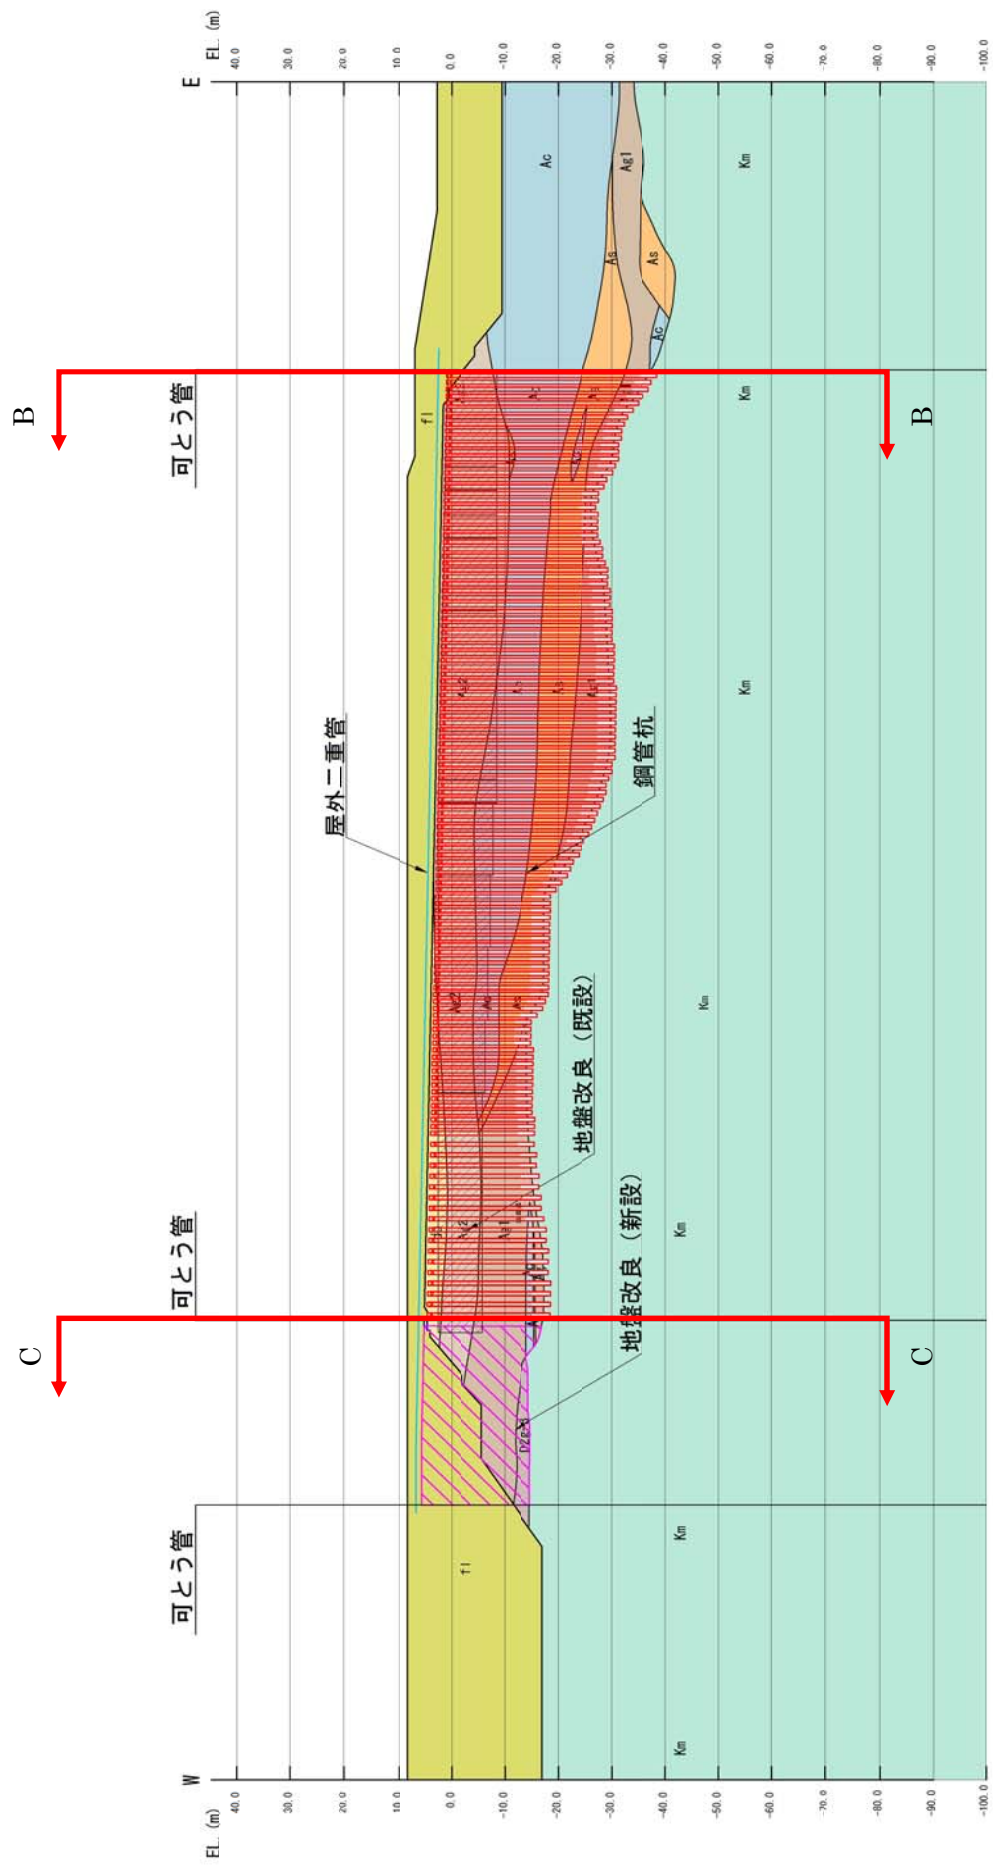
(1) 屋外二重管基礎の評価対象断面図 (A-A断面)
